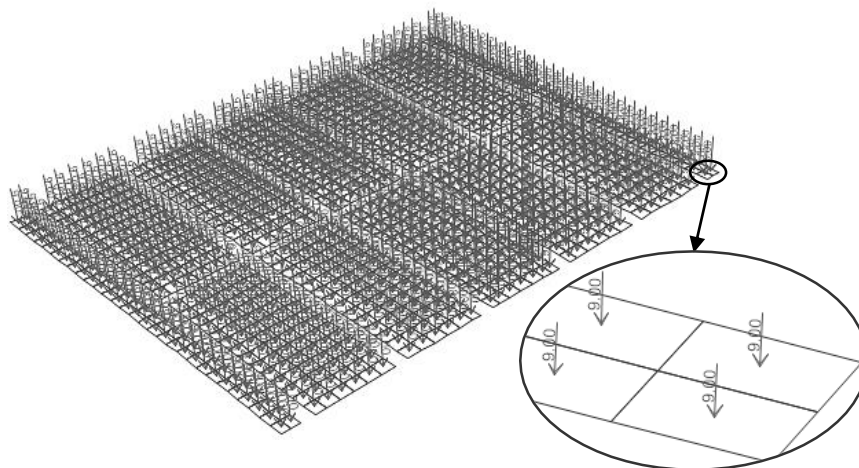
Sobrecarga uniformemente distribuída na laje de acesso
